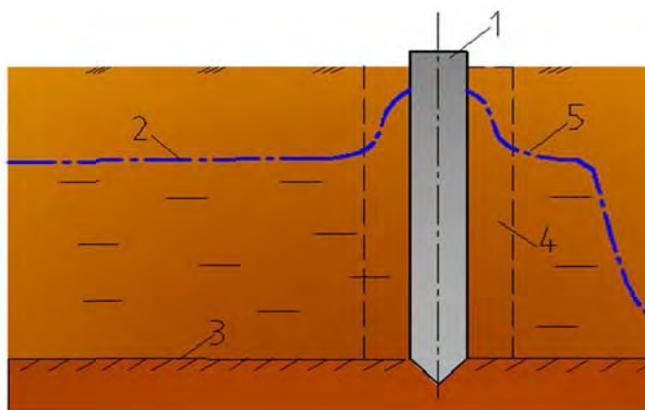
Изменение уровня грунтовых вод в результате погружения одиночной сваи (ряда свай): 1) свая; 2) естественный уровень грунтовых вод с верховой стороны потока; 3) водоупорный грунт; 4) уплотненный (околосвайный) грунт; 5) нарушенный уровень грунтовых вод по течению после техногенного препятствия
